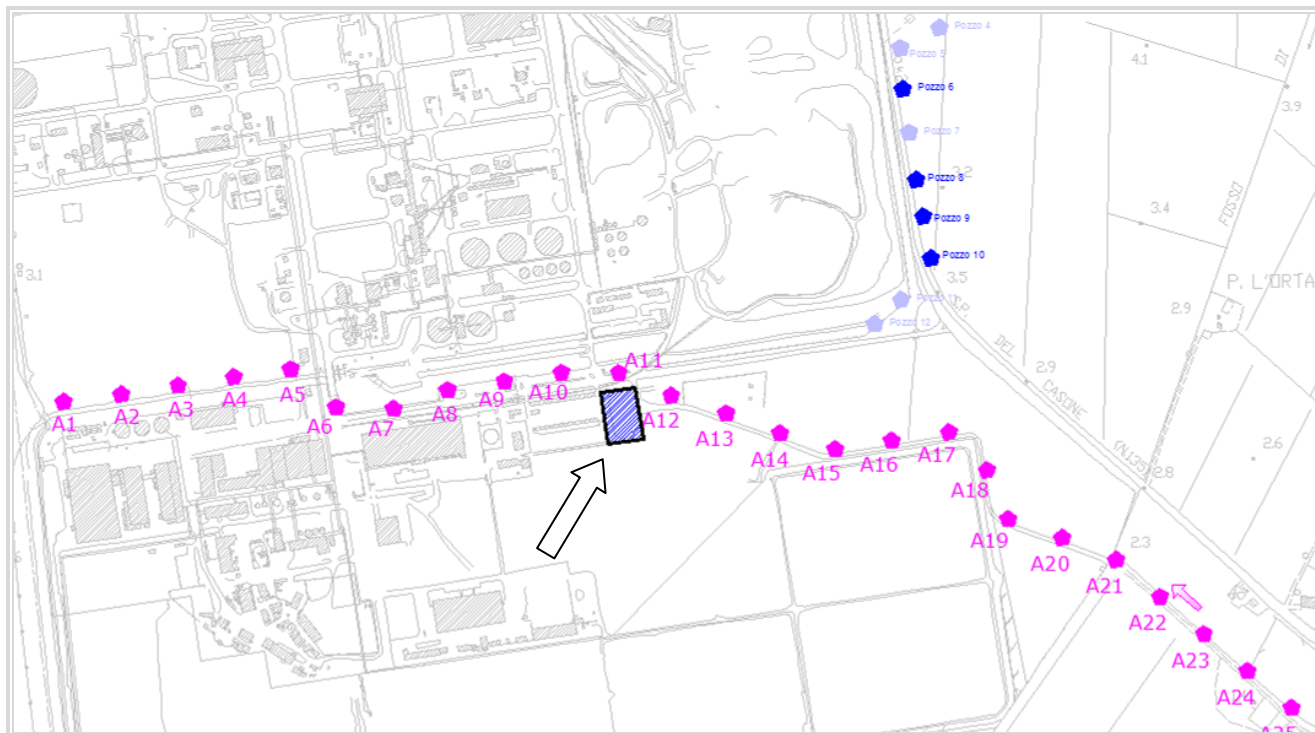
Stralcio planimetrico con ubicazione area logistica principale (area baracche, stoccaggi materiale, etc.)
